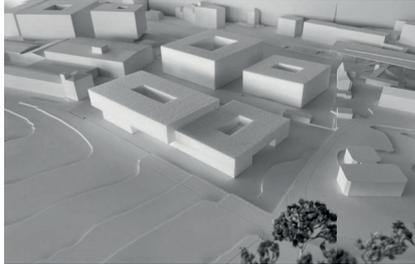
Minimalvariante mit möglicher Entwicklung fenaco Areal, 2. Workshop, April 2023
